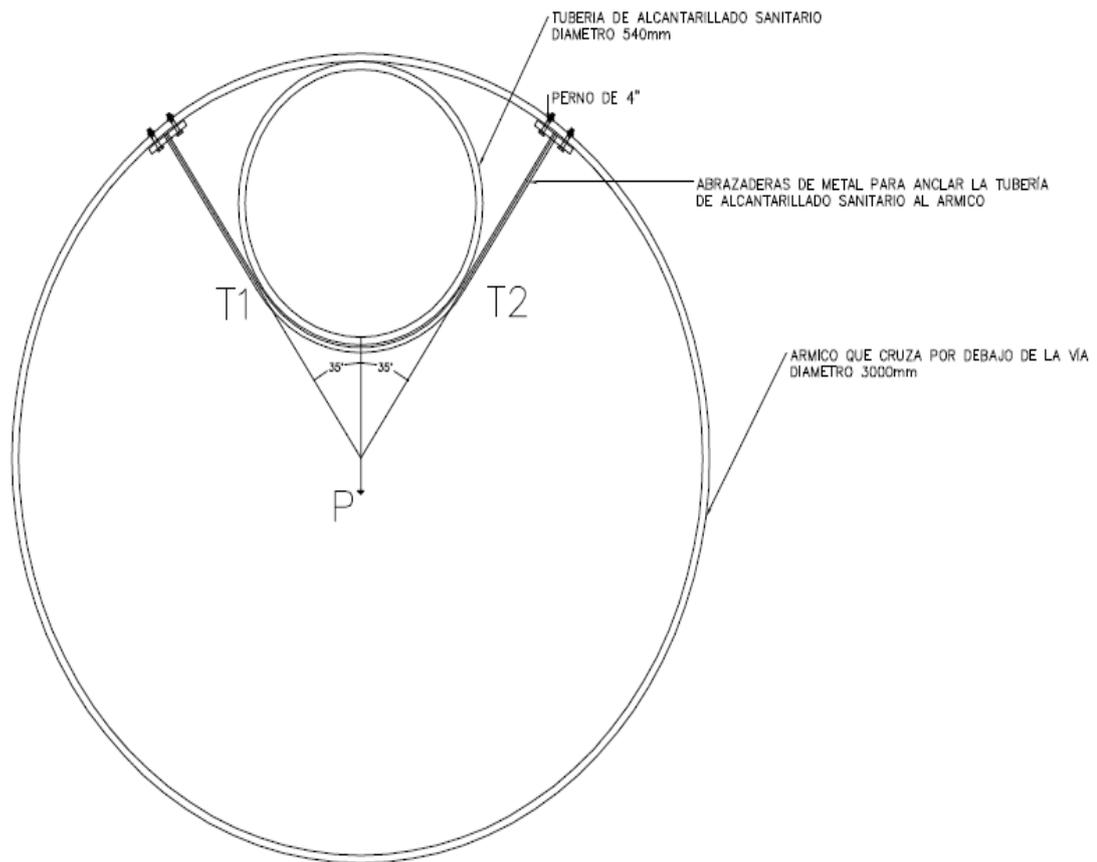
Detalle de la tubería con las abrazaderas su diseño
